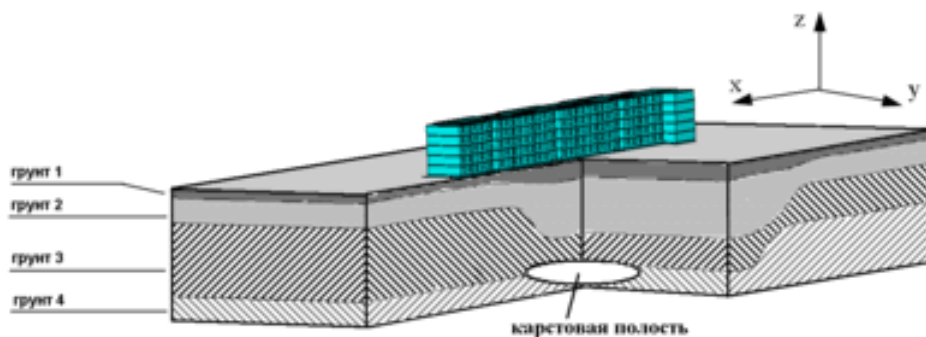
Расчетная схема системы «карст – грунтовое основание – фундамент – сооружение»
